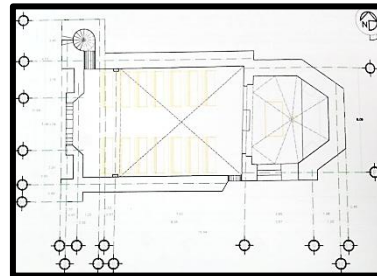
Planta arquitectónica de la Parroquia de Santa María de las Rosas. (Esquivel, 2016)
